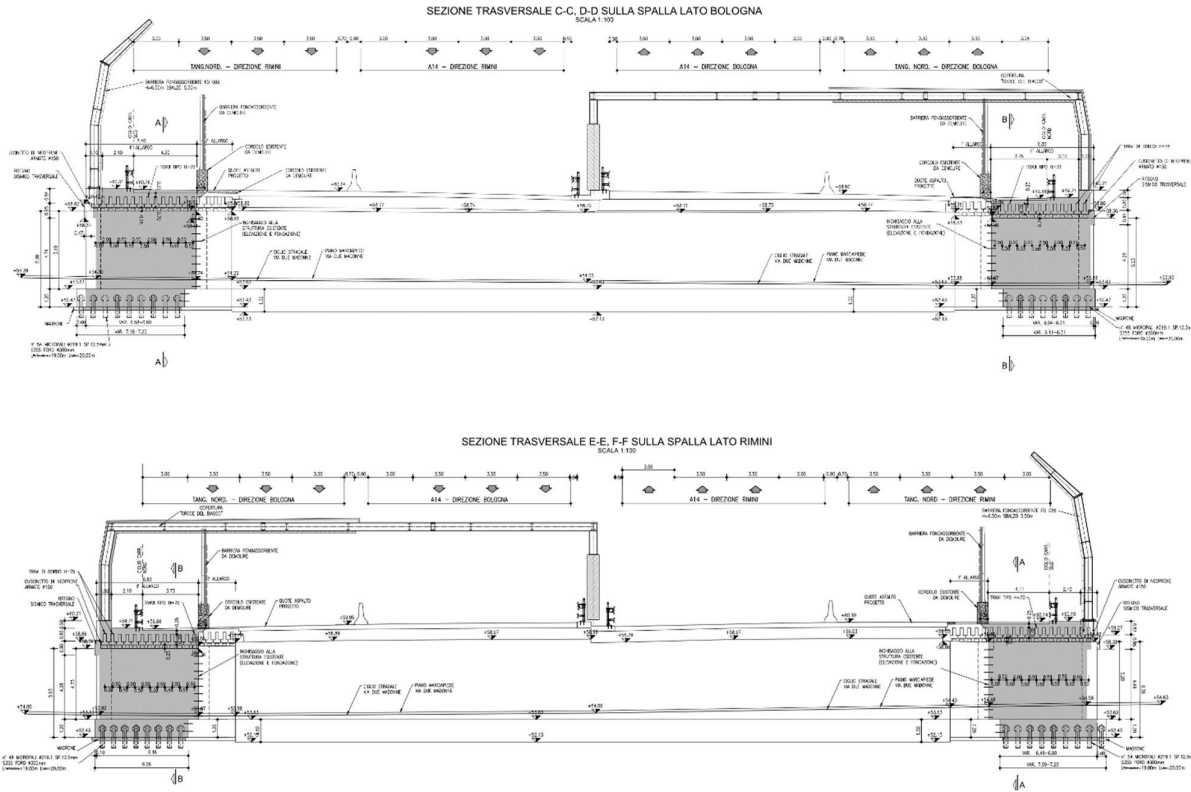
Sezioni trasversali sulle spalle
